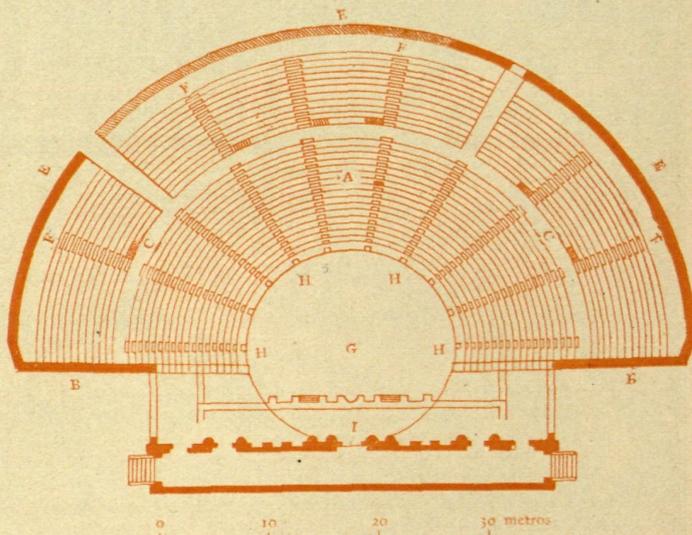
PLANTA DEL TEATRO DE SEGESTO
